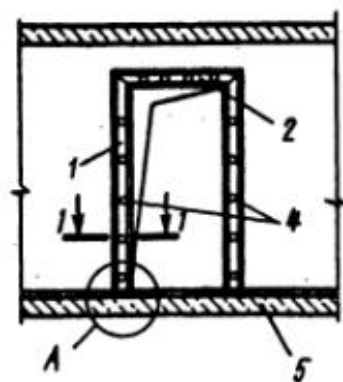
Усиления граней расширяемого проема стальной рамой: 1 – стальная стойка, 2 – стальной ригель, 3 – стеновая панель, 4 – стяжной болт, 5 – панель перекрытия, 6 – стальные клинья
